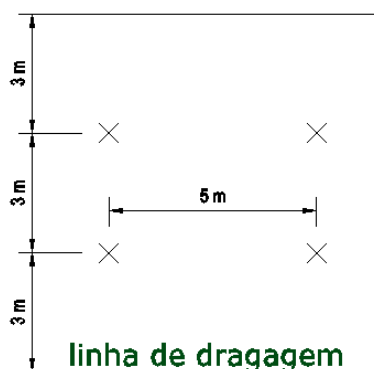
Disposição das ancoragens consoante a alternativa adotada.
